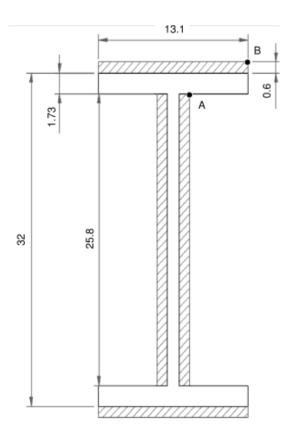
Perfil IPN320 y filetes de soldadura
